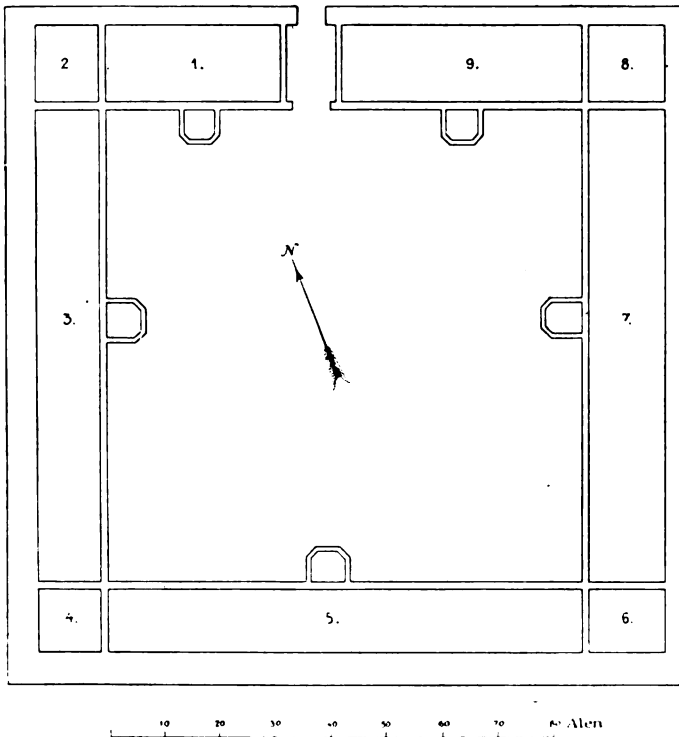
Det yngre Krogen. Plan af Kælderen.
